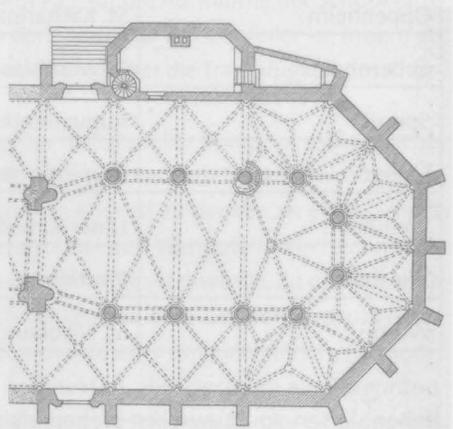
Der Chor der Heiliggeistkirche, Grundriss (Zahn: Heiliggeistkirche, wie Anm. 2, Tafel 2)
